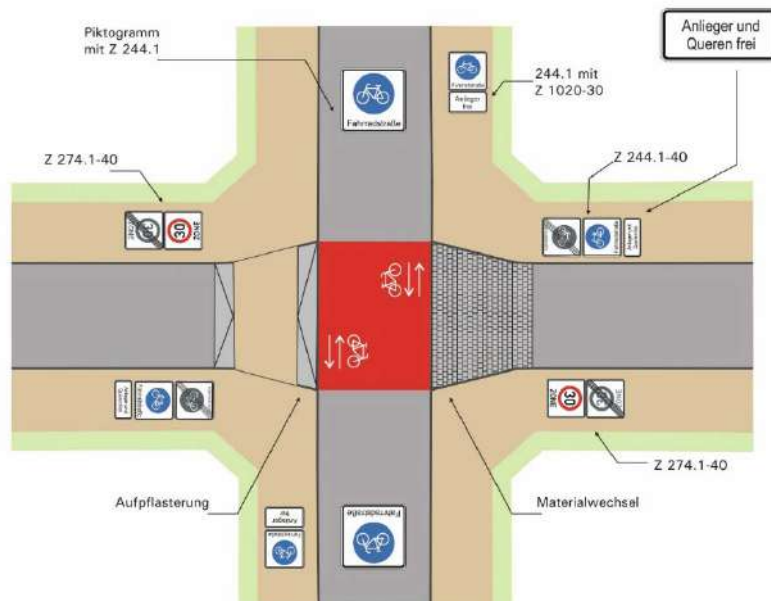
Mögliche bauliche Bevorrechtigung einer Fahrradstraße
